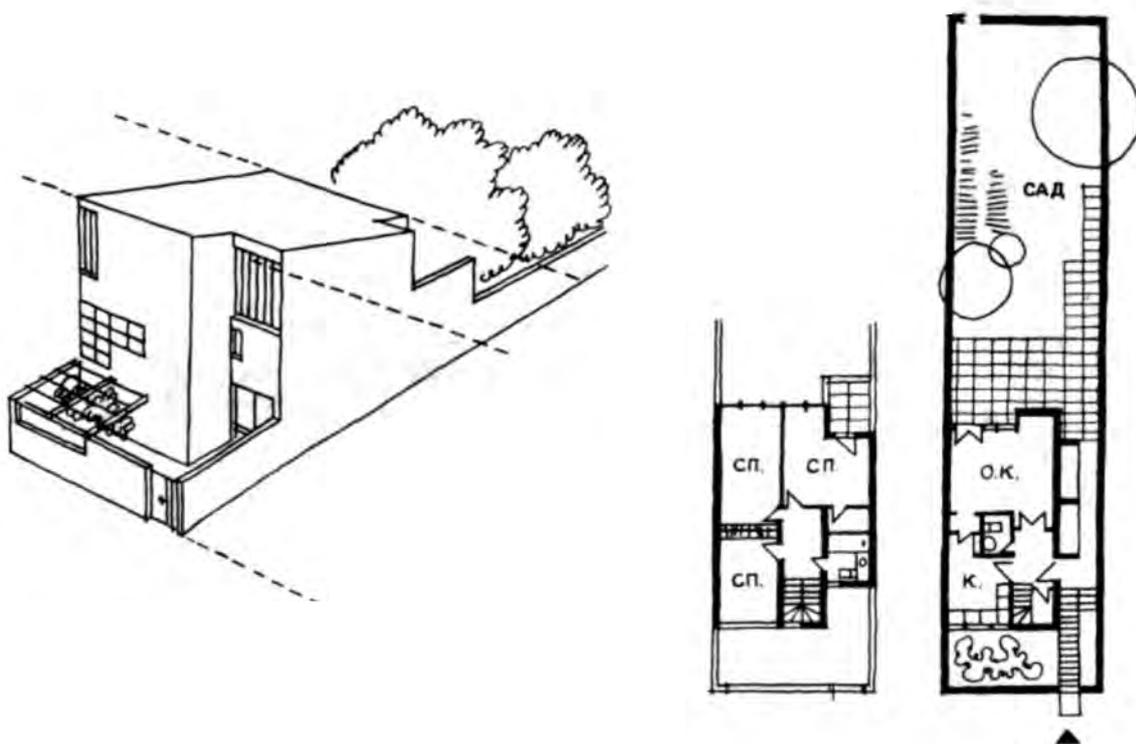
Четырехкомнатная двухэтажная блок-квартира со сквозным проходом на участке вне дома. Фасад, план
